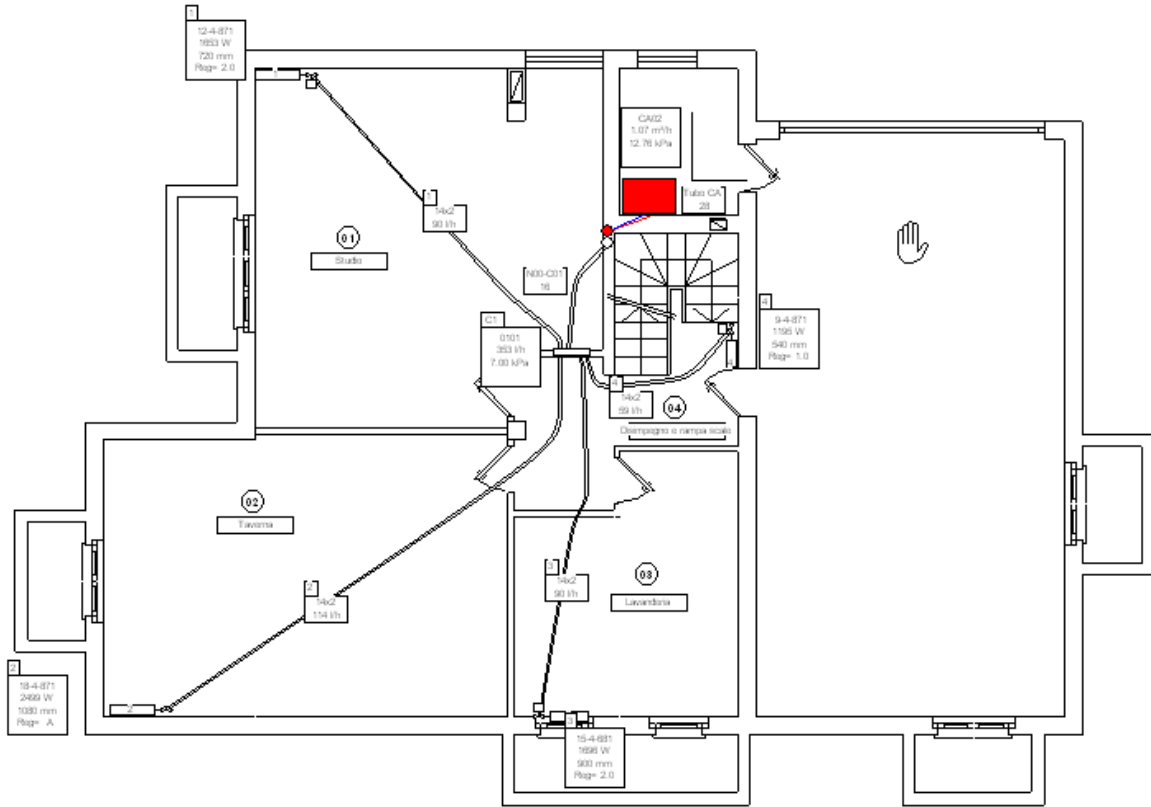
Distribuzione in edificio a due piani: piano Primo
